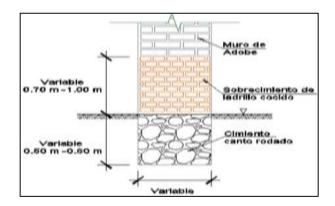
Cimentación Fuente: Cárdenas (2008)
